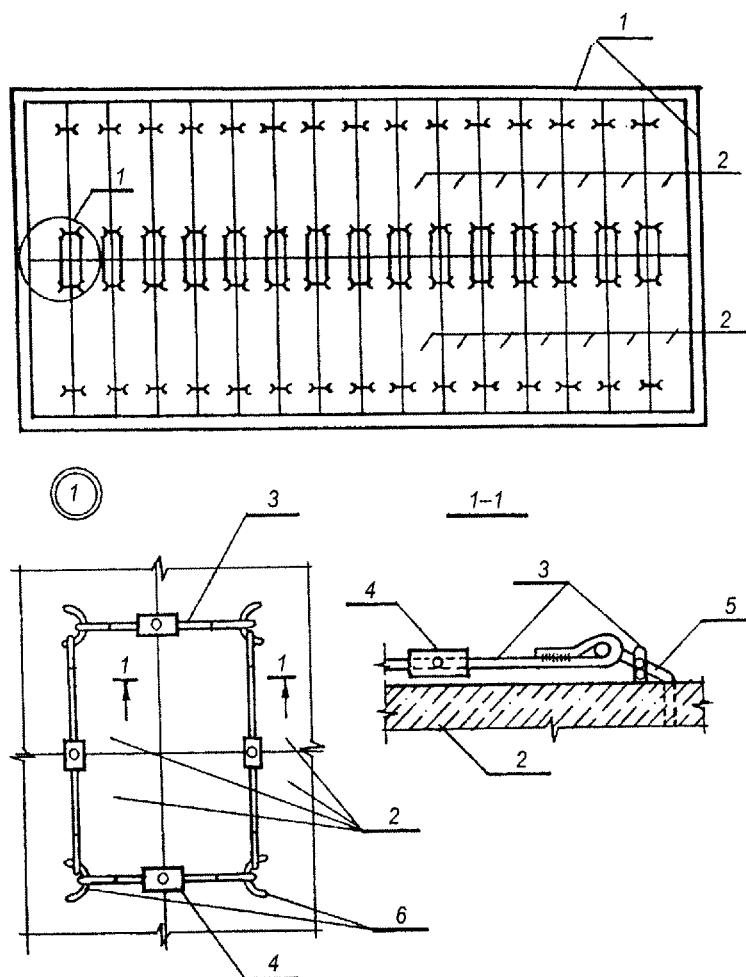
Схема устройства жесткого горизонтального диска в здании путем установки анкерных связей между подъемными петлями панелей перекрытий: 1 – стены здания; 2 – железобетонные панели перекрытия; 3 – анкерная связь; 4 – стяжная муфта; 5, 6 – подъемная петля
